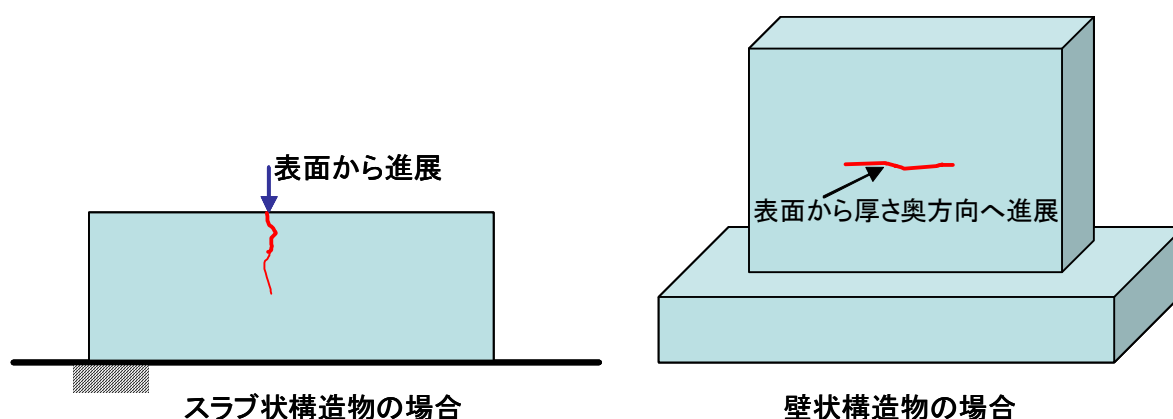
表面ひび割れ幅法が解析の対象とするひび割れ
